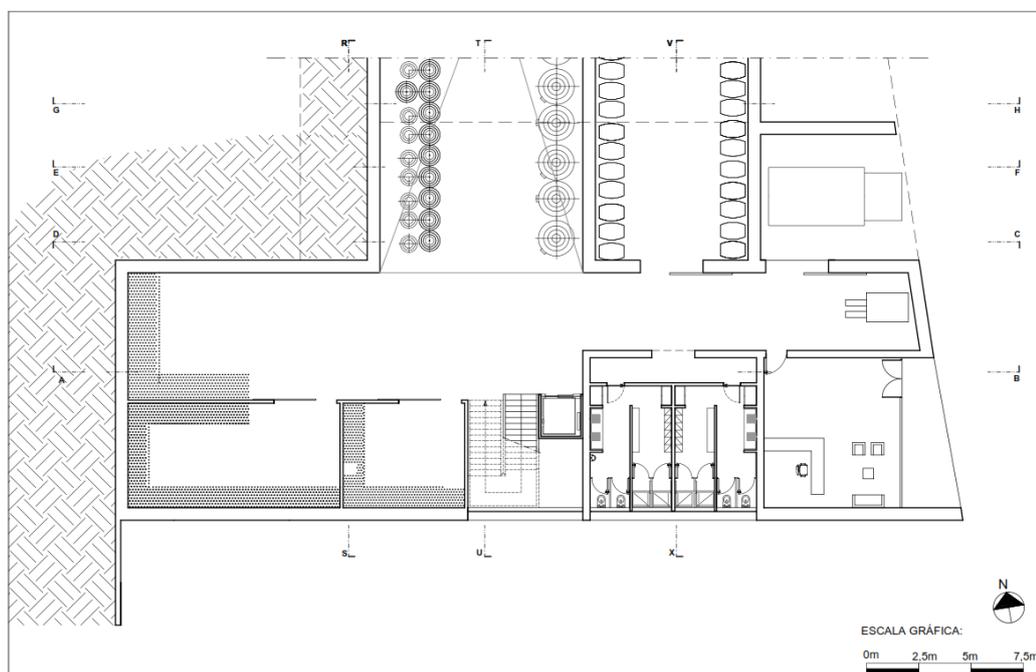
Planta da Semi-cave da adega – Edifício de engarrafamento do vinho¹⁰¹
